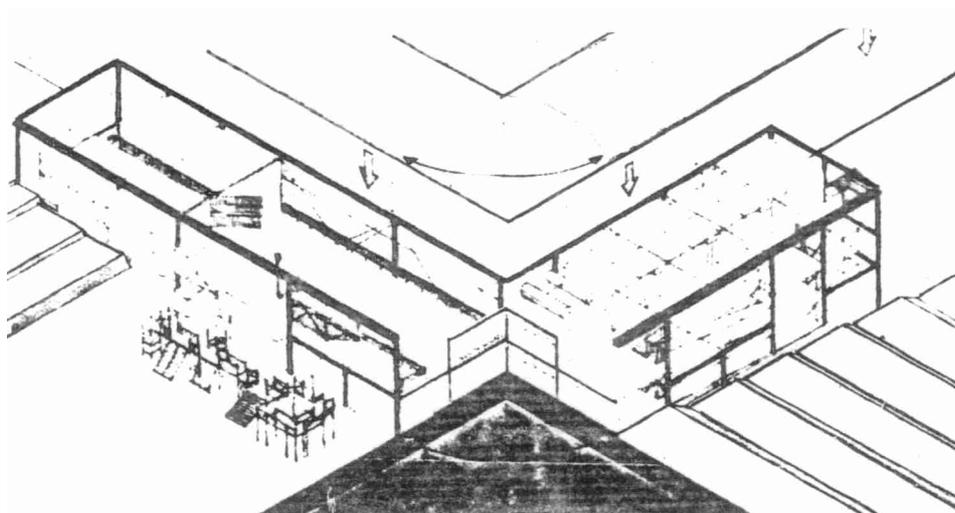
Sistema construtivo, estrutura em aço com crescimento vertical - 1º prêmio (Éolo Maia, Podesta, Josefina Maia).
